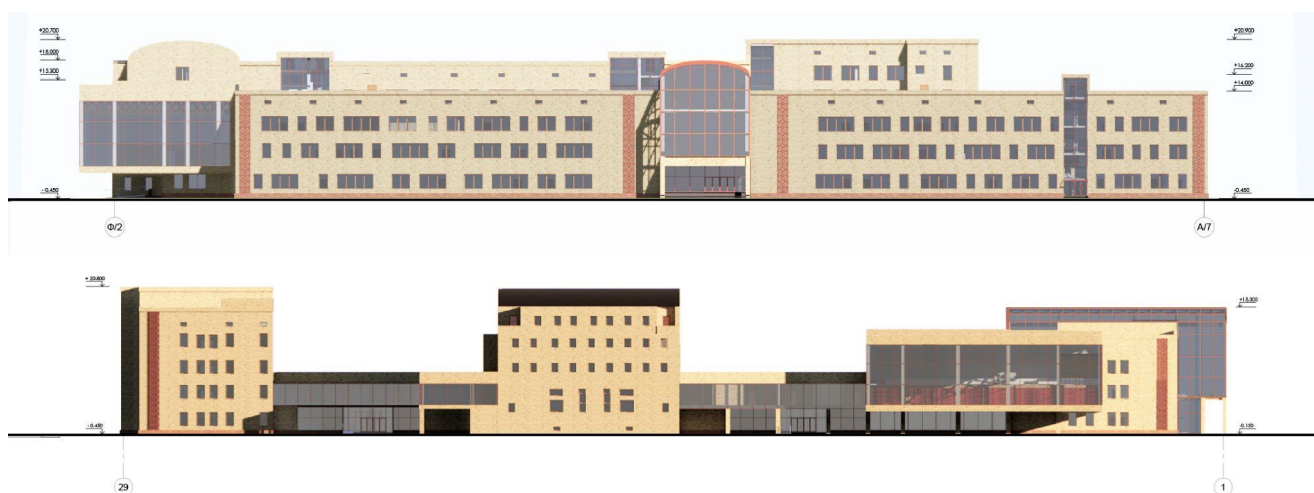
Фасад в осях Ф/2-А/7, Фасад в осях 29-1
